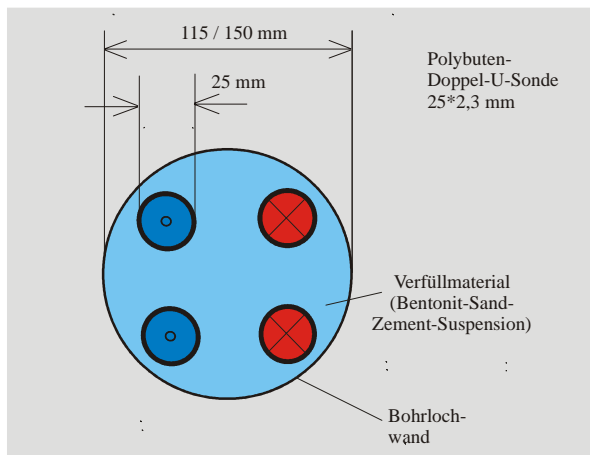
Aufbau einer Erdwärmesonden-Bohrung
